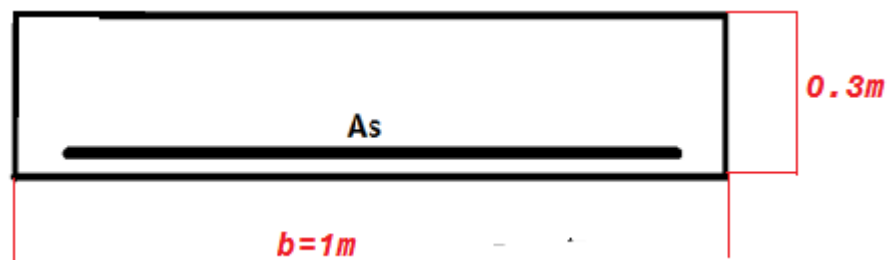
Ferrailage longitudinal de la dalle de transition
